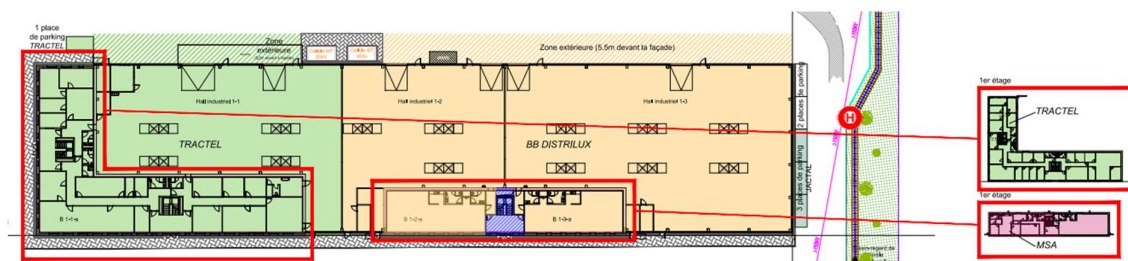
Implantation de BB DISTRILUX (secteur jaune) sur le site SISA, détail du hall 1 (Source : SISA FOETZ).
